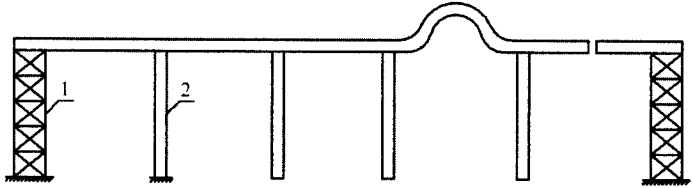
Схема опор надземного трубопроводу: 1 – анкерні; 2 – проміжні
